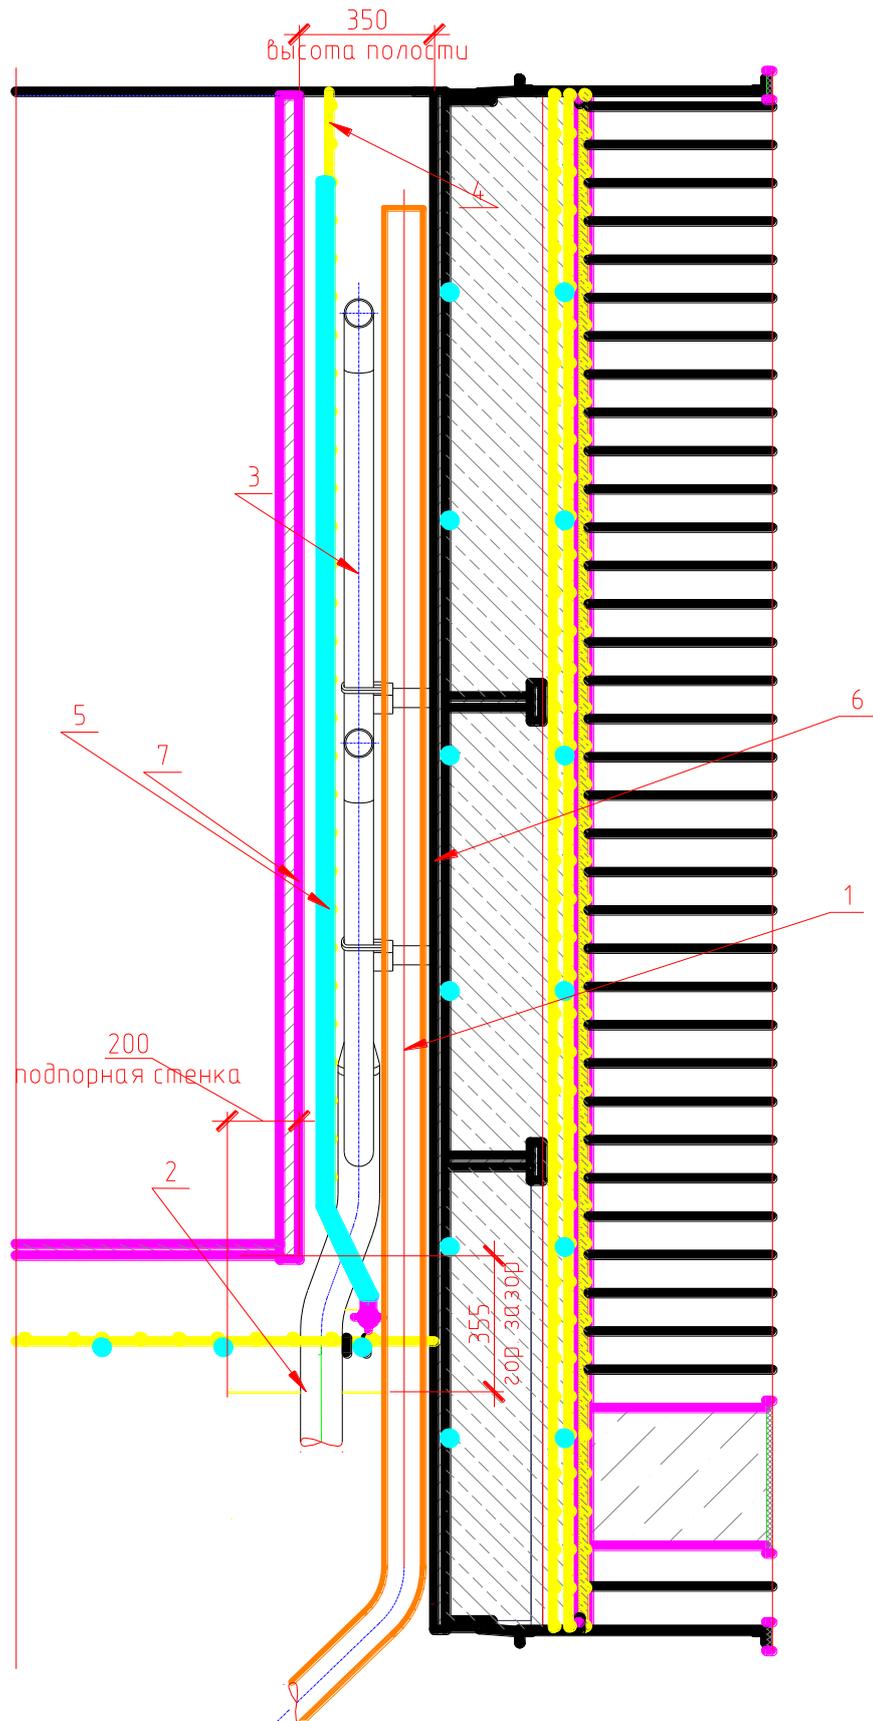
Схема полости(разрез): 1 – бетоновод; 2 - кольцевая съемная опалубка; 3 – трубопроводы; 4- арматурная сетка; 5 – гибкие гофр.трубки; 6 – нижняя металлическая плита; 7 – верхняя металлическая плита.
